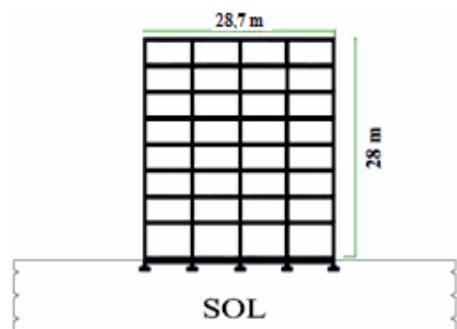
Bâtiment en béton armé de sept étages sur réez de chaussé en 2D.
